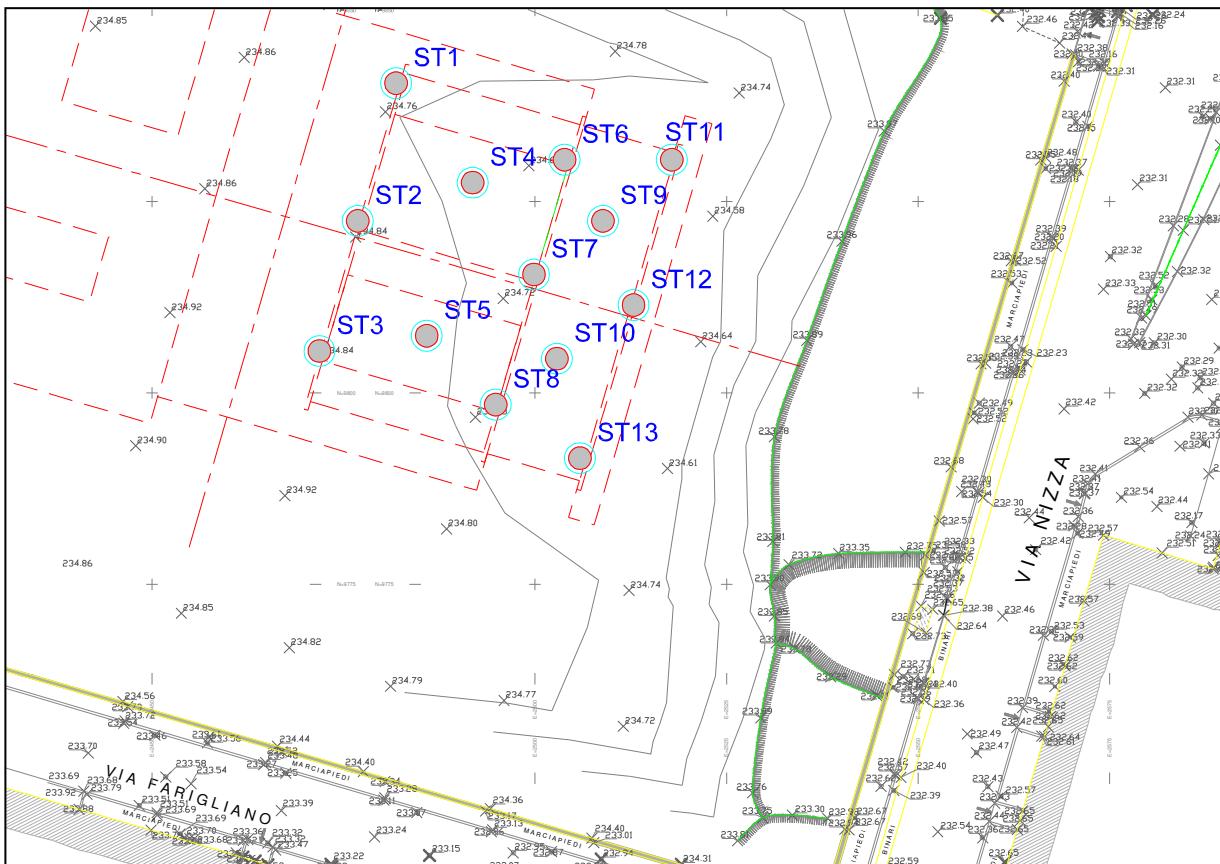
stralcio planimetrico con l'ubicazione dei fori da sondaggio utilizzati per l'indagine cross-hole.
